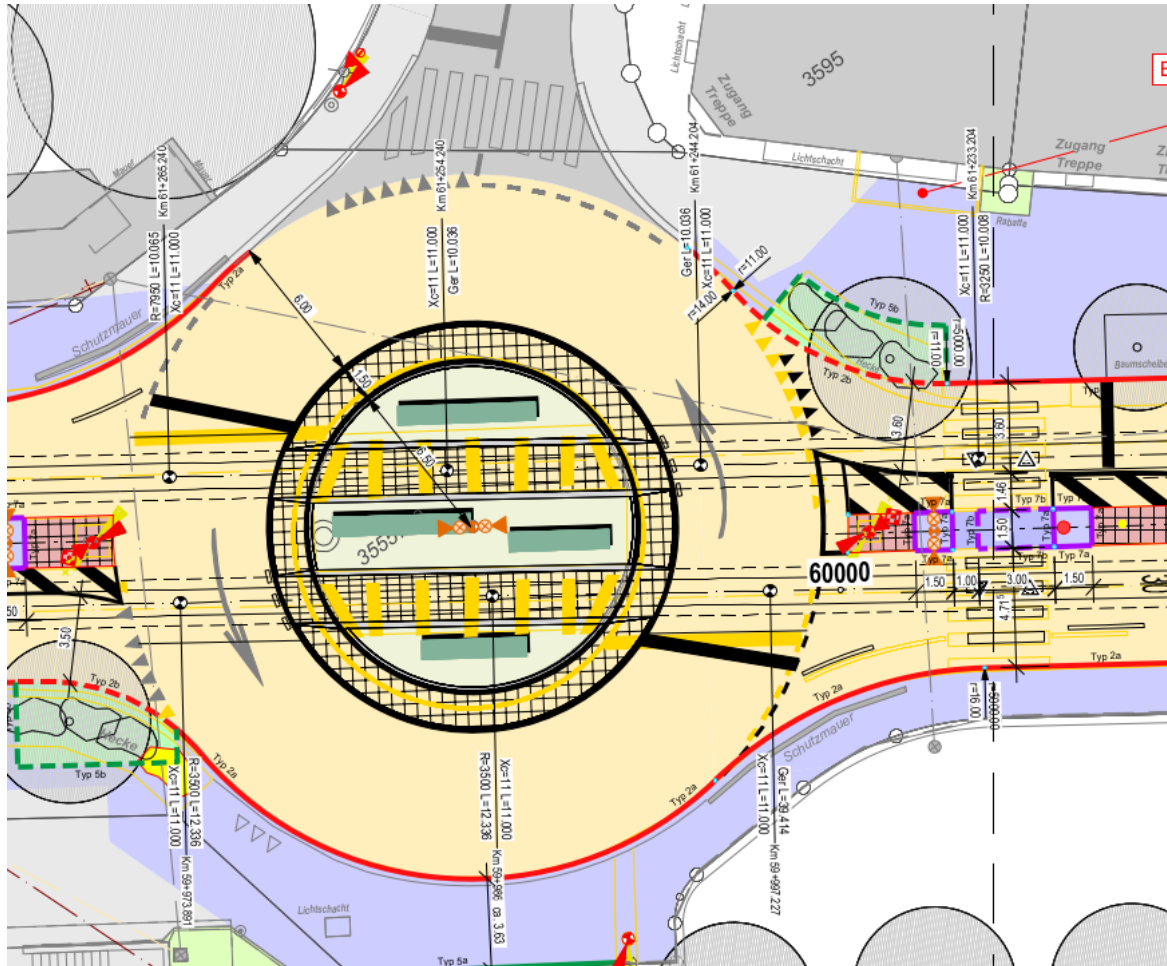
Planausschnitt aus Situationsplan. „Kreisel Eichholz - Kreisel Grünau“
